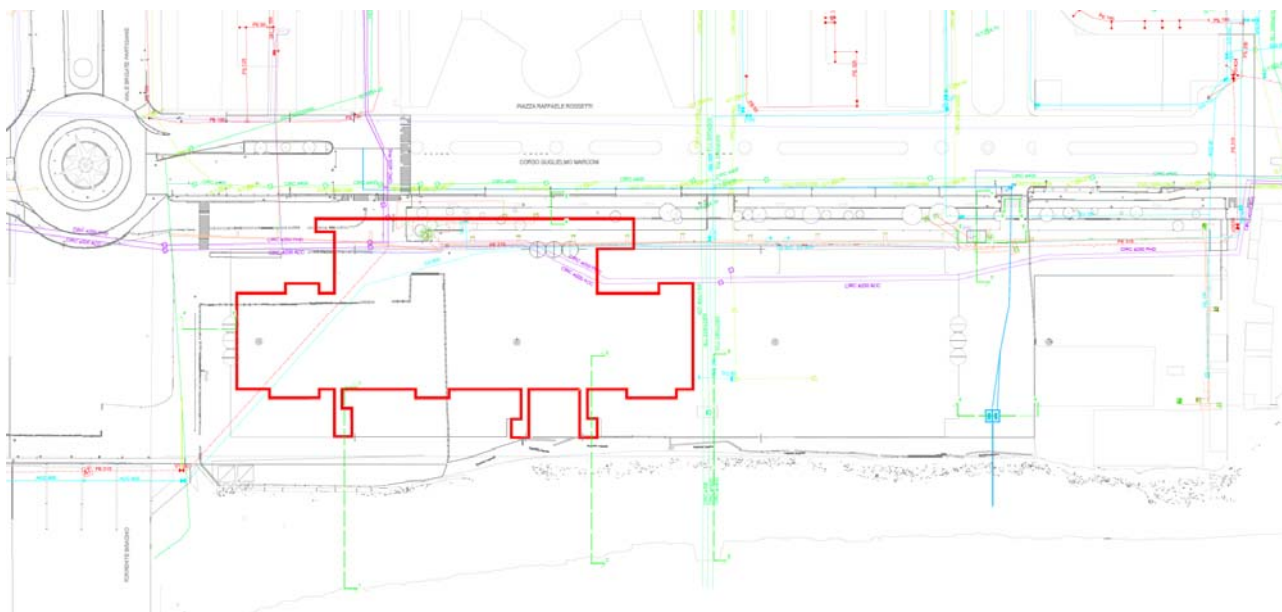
Planimetria dello stato di fatto con individuazione del volume dell'autorimessa di progetto
